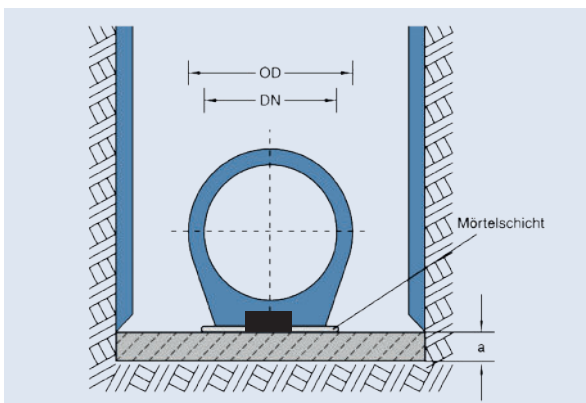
Betonbettung für Rohre mit Fuß und Nut auf Mörtelschicht
